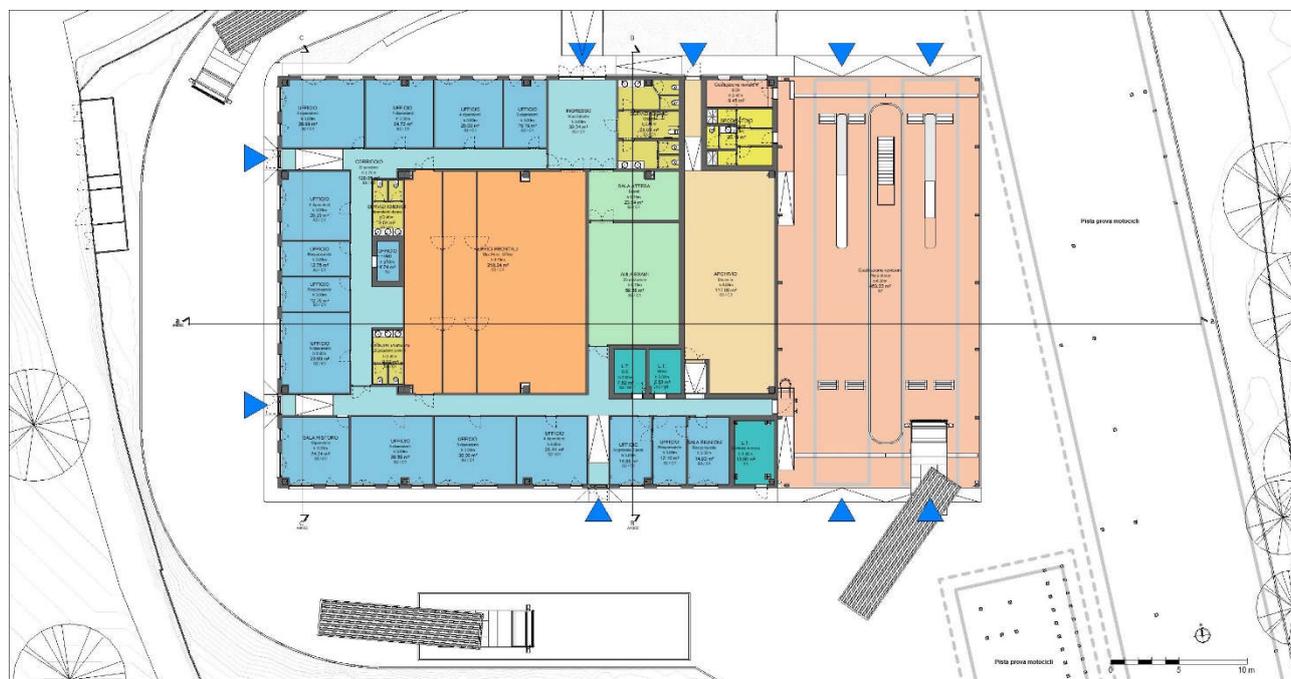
Planimetria del lotto di progetto – illustrazione della nuova sagoma dell’edificio e della predisposizione delle aree esterne – Fuori scala
